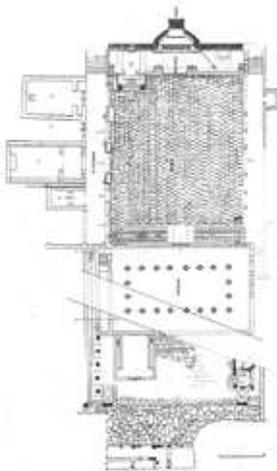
Pianta del foro di Baelo Claudia a Belo.
